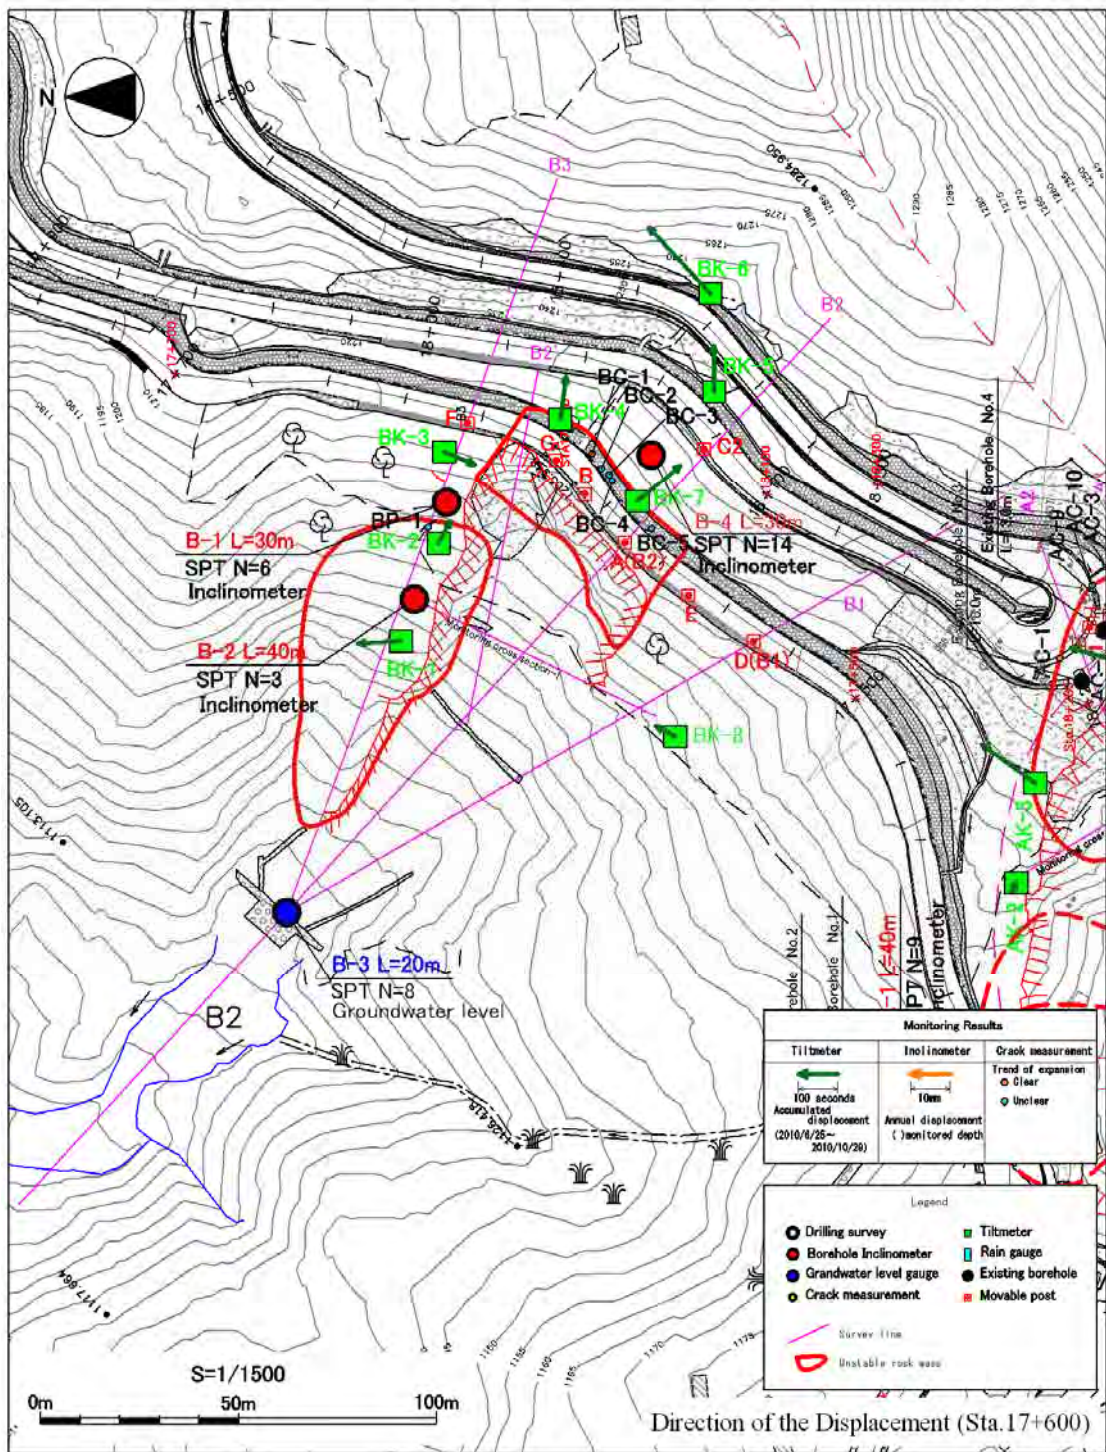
斜変動方向を記入した平面図 (出典：調査団)
